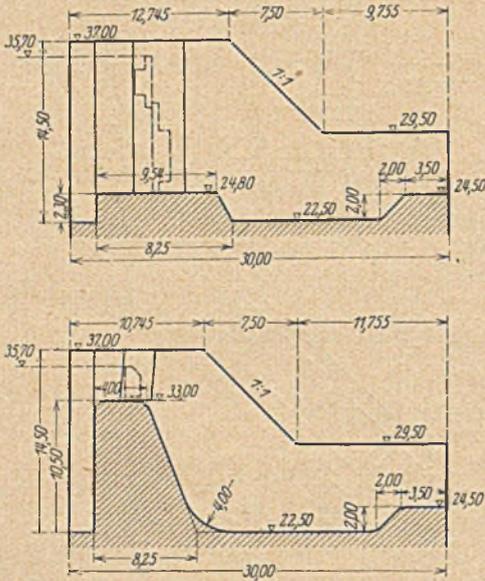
und 5. Längsschnitt durch die Überfall- und Grundabläßöffnungen des ursprünglichen Entwurfes.
